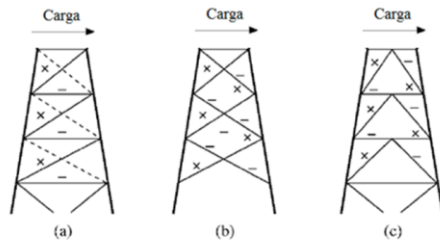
Sistemas de arriotramiento; (a) disposición Z o armadura tipo Pratt; (b) armadura tipo Warren y (c) armadura tipo Delta.
